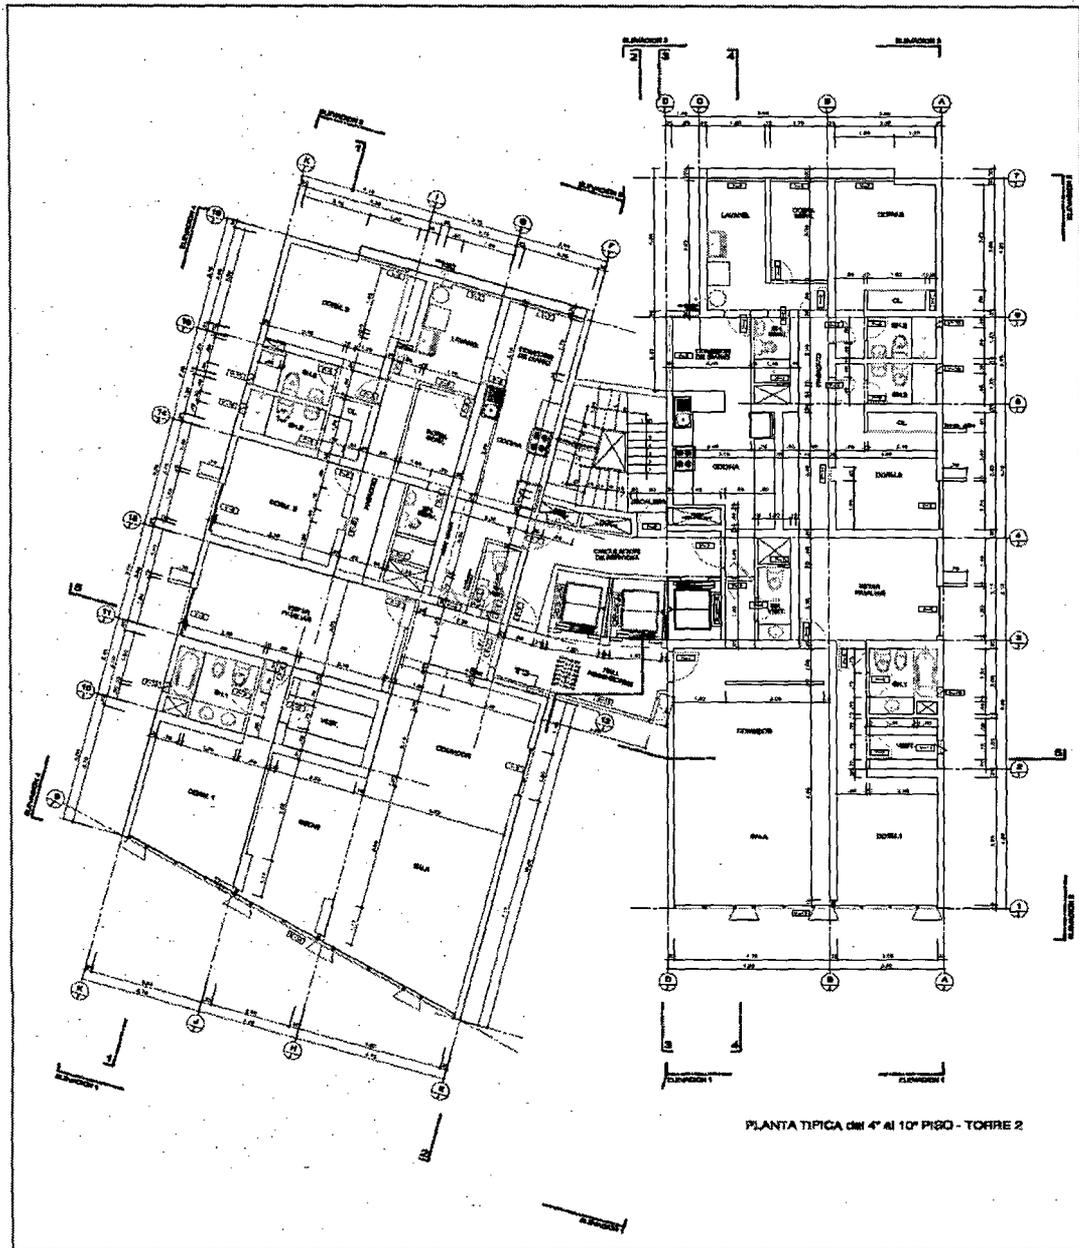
Planta Típica Torre 2 del proyecto Golf Millenium
